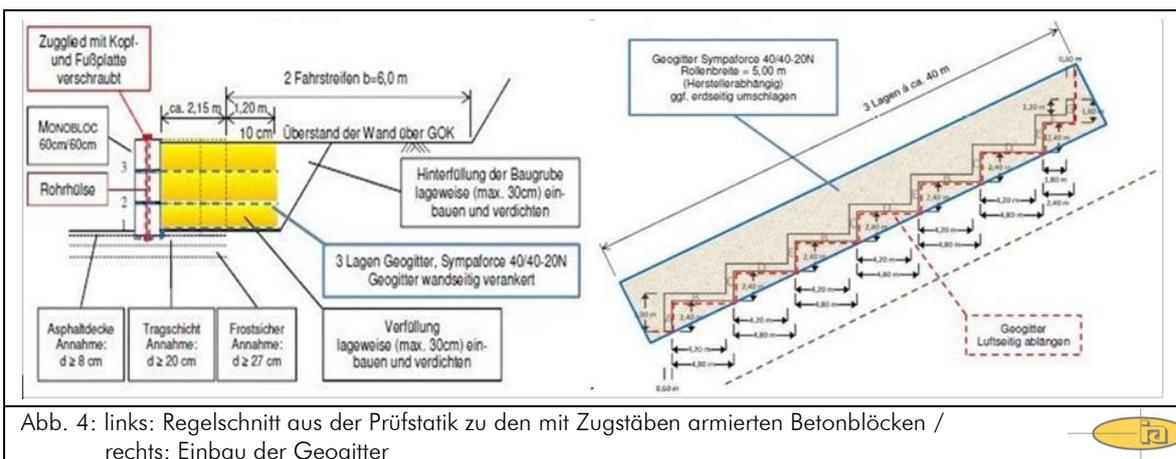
links: Regelschnitt aus der Prüfstatik zu den mit Zugstäben armierten Betonblöcken / rechts: Einbau der Geogitter
